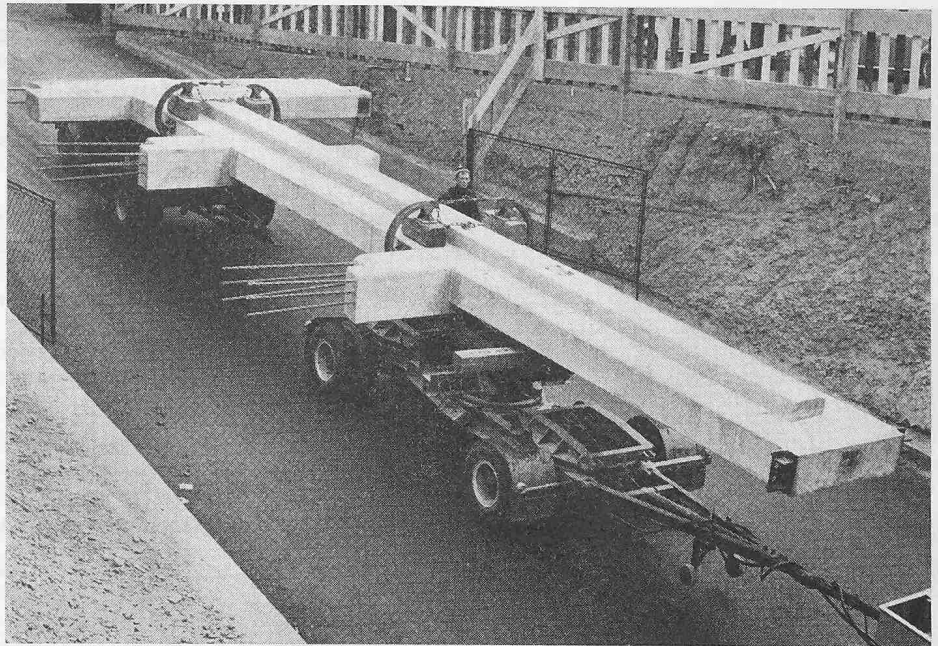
Antransport einer Erdgeschoss-Stütze zur Baugrube. Die seitlichen Anschlusseisen bei den Konsolen dienen zur Aufnahme des Ortbetons in den Randzonen bei den Türmen
